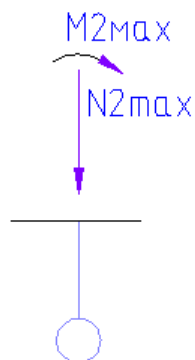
Схема приложения нагрузки от несущих колонн
